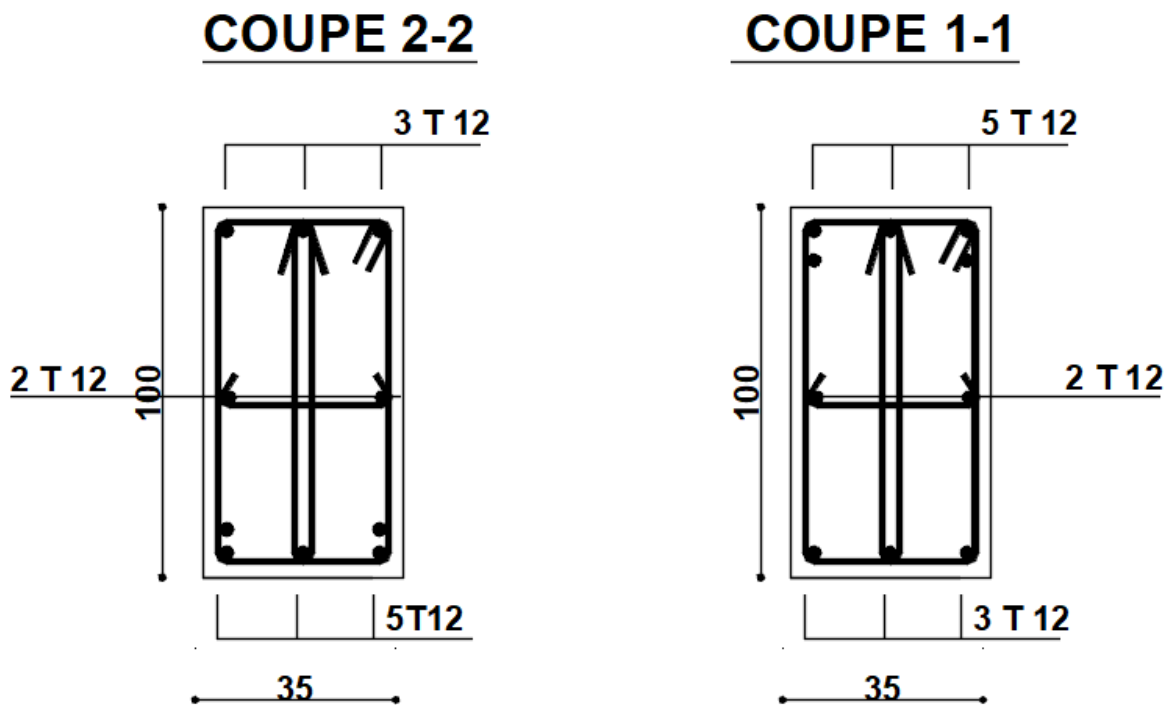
Ferrailage de poutre seconder Radier.
